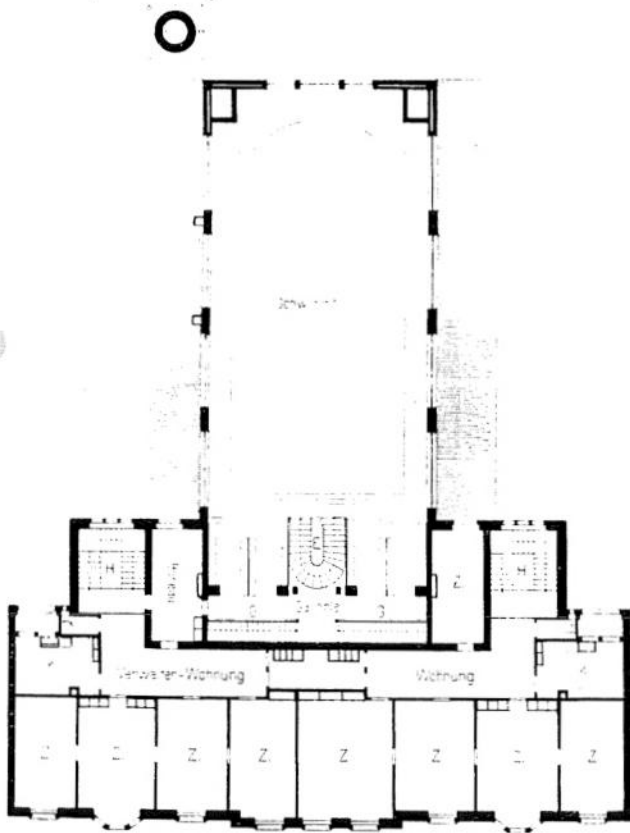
Grundriss vom ersten Obergeschoss. — 1:400.
